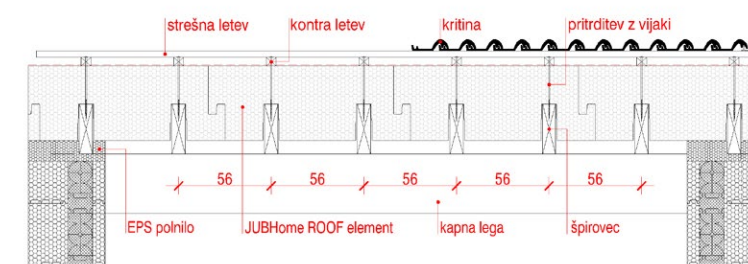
Prikaz konstrukcije strehe z JUBHome ROOF elementi
